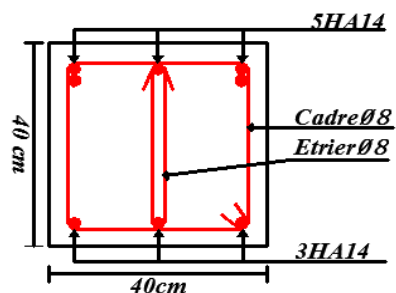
Schéma de ferrailage de la poutre de palière en appuis
